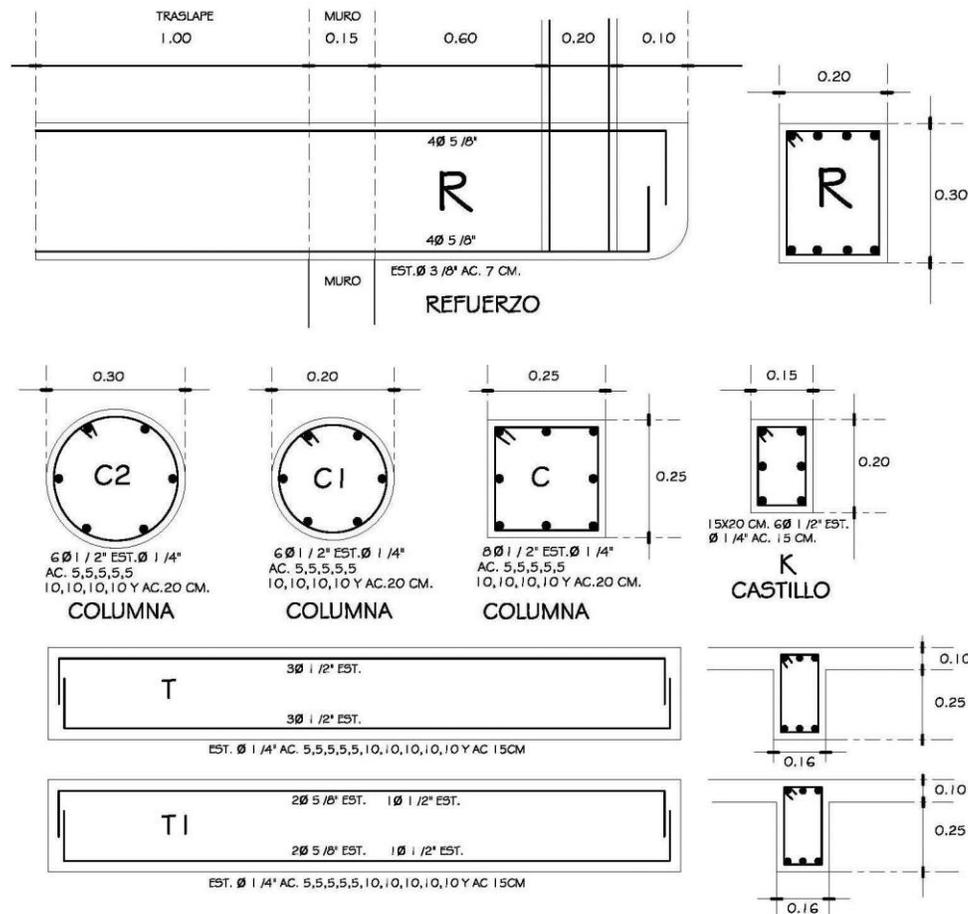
Tipo y diseño de trabes y cadenas de cerramiento
